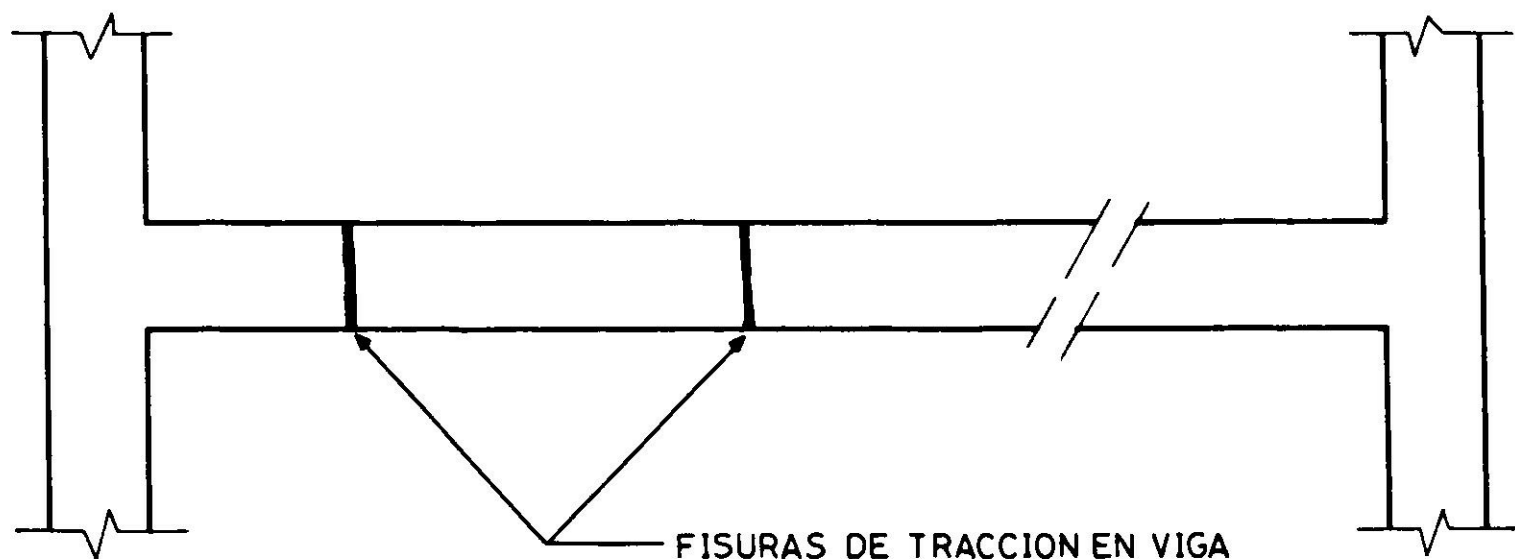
Agrietamiento de una viga por flexión.
